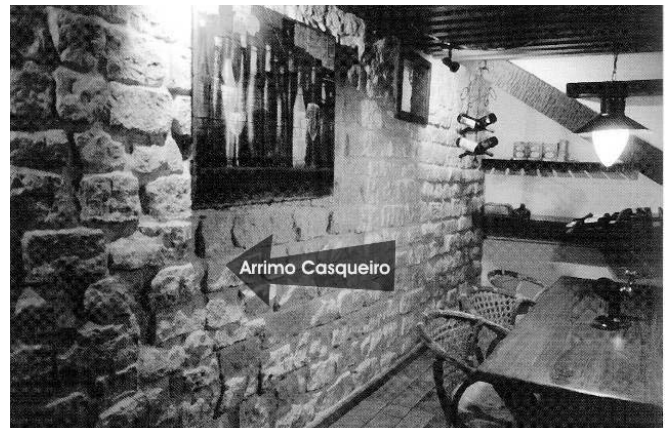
Adega. Arrimo com blocos de casqueiro. Obra R. Azevedo. Capa e matéria da Revista Pedras do Brasil. 2002 (foto do César Romero).
